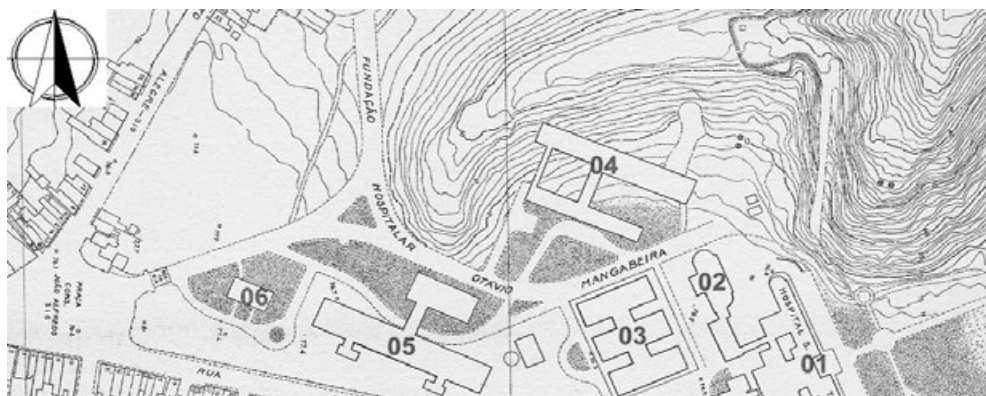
Planta de localização dos diversos pavilhões do Parque Sanatorial Santa Terezinha (entre parênteses o ano de inauguração): 01 Hospital Santa Terezinha (1942); 02 Pavilhão infantil (1948); 03 Pavilhão de Serviços Gerais (1951); 04 Sanatório de Triagem (1951); 05 Pavilhão de Triagem (1951); 06 Dispensário Modelo da Cruz Vermelha (1951).
